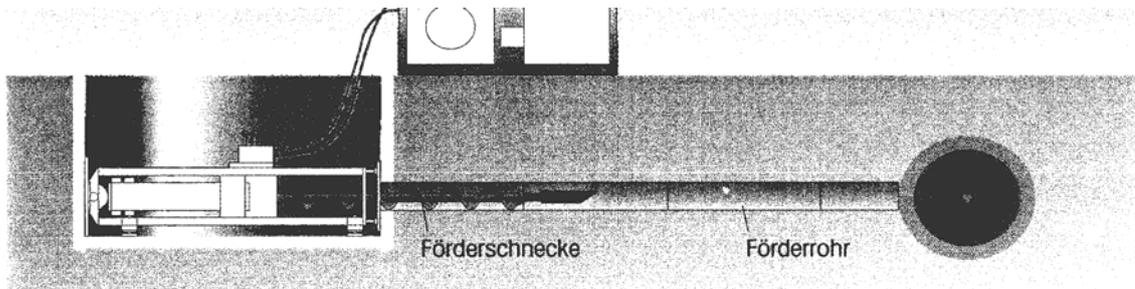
Rückziehen der Förderschnecke mit dem Pilotrohr [1]
